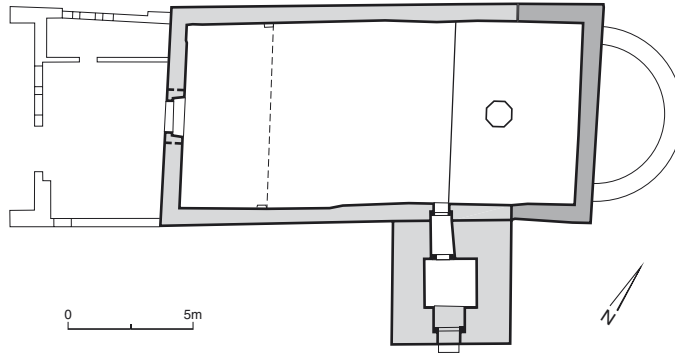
Leissigen. Kirche von 1675, rekonstruierter Grundriss. M 1:300.
